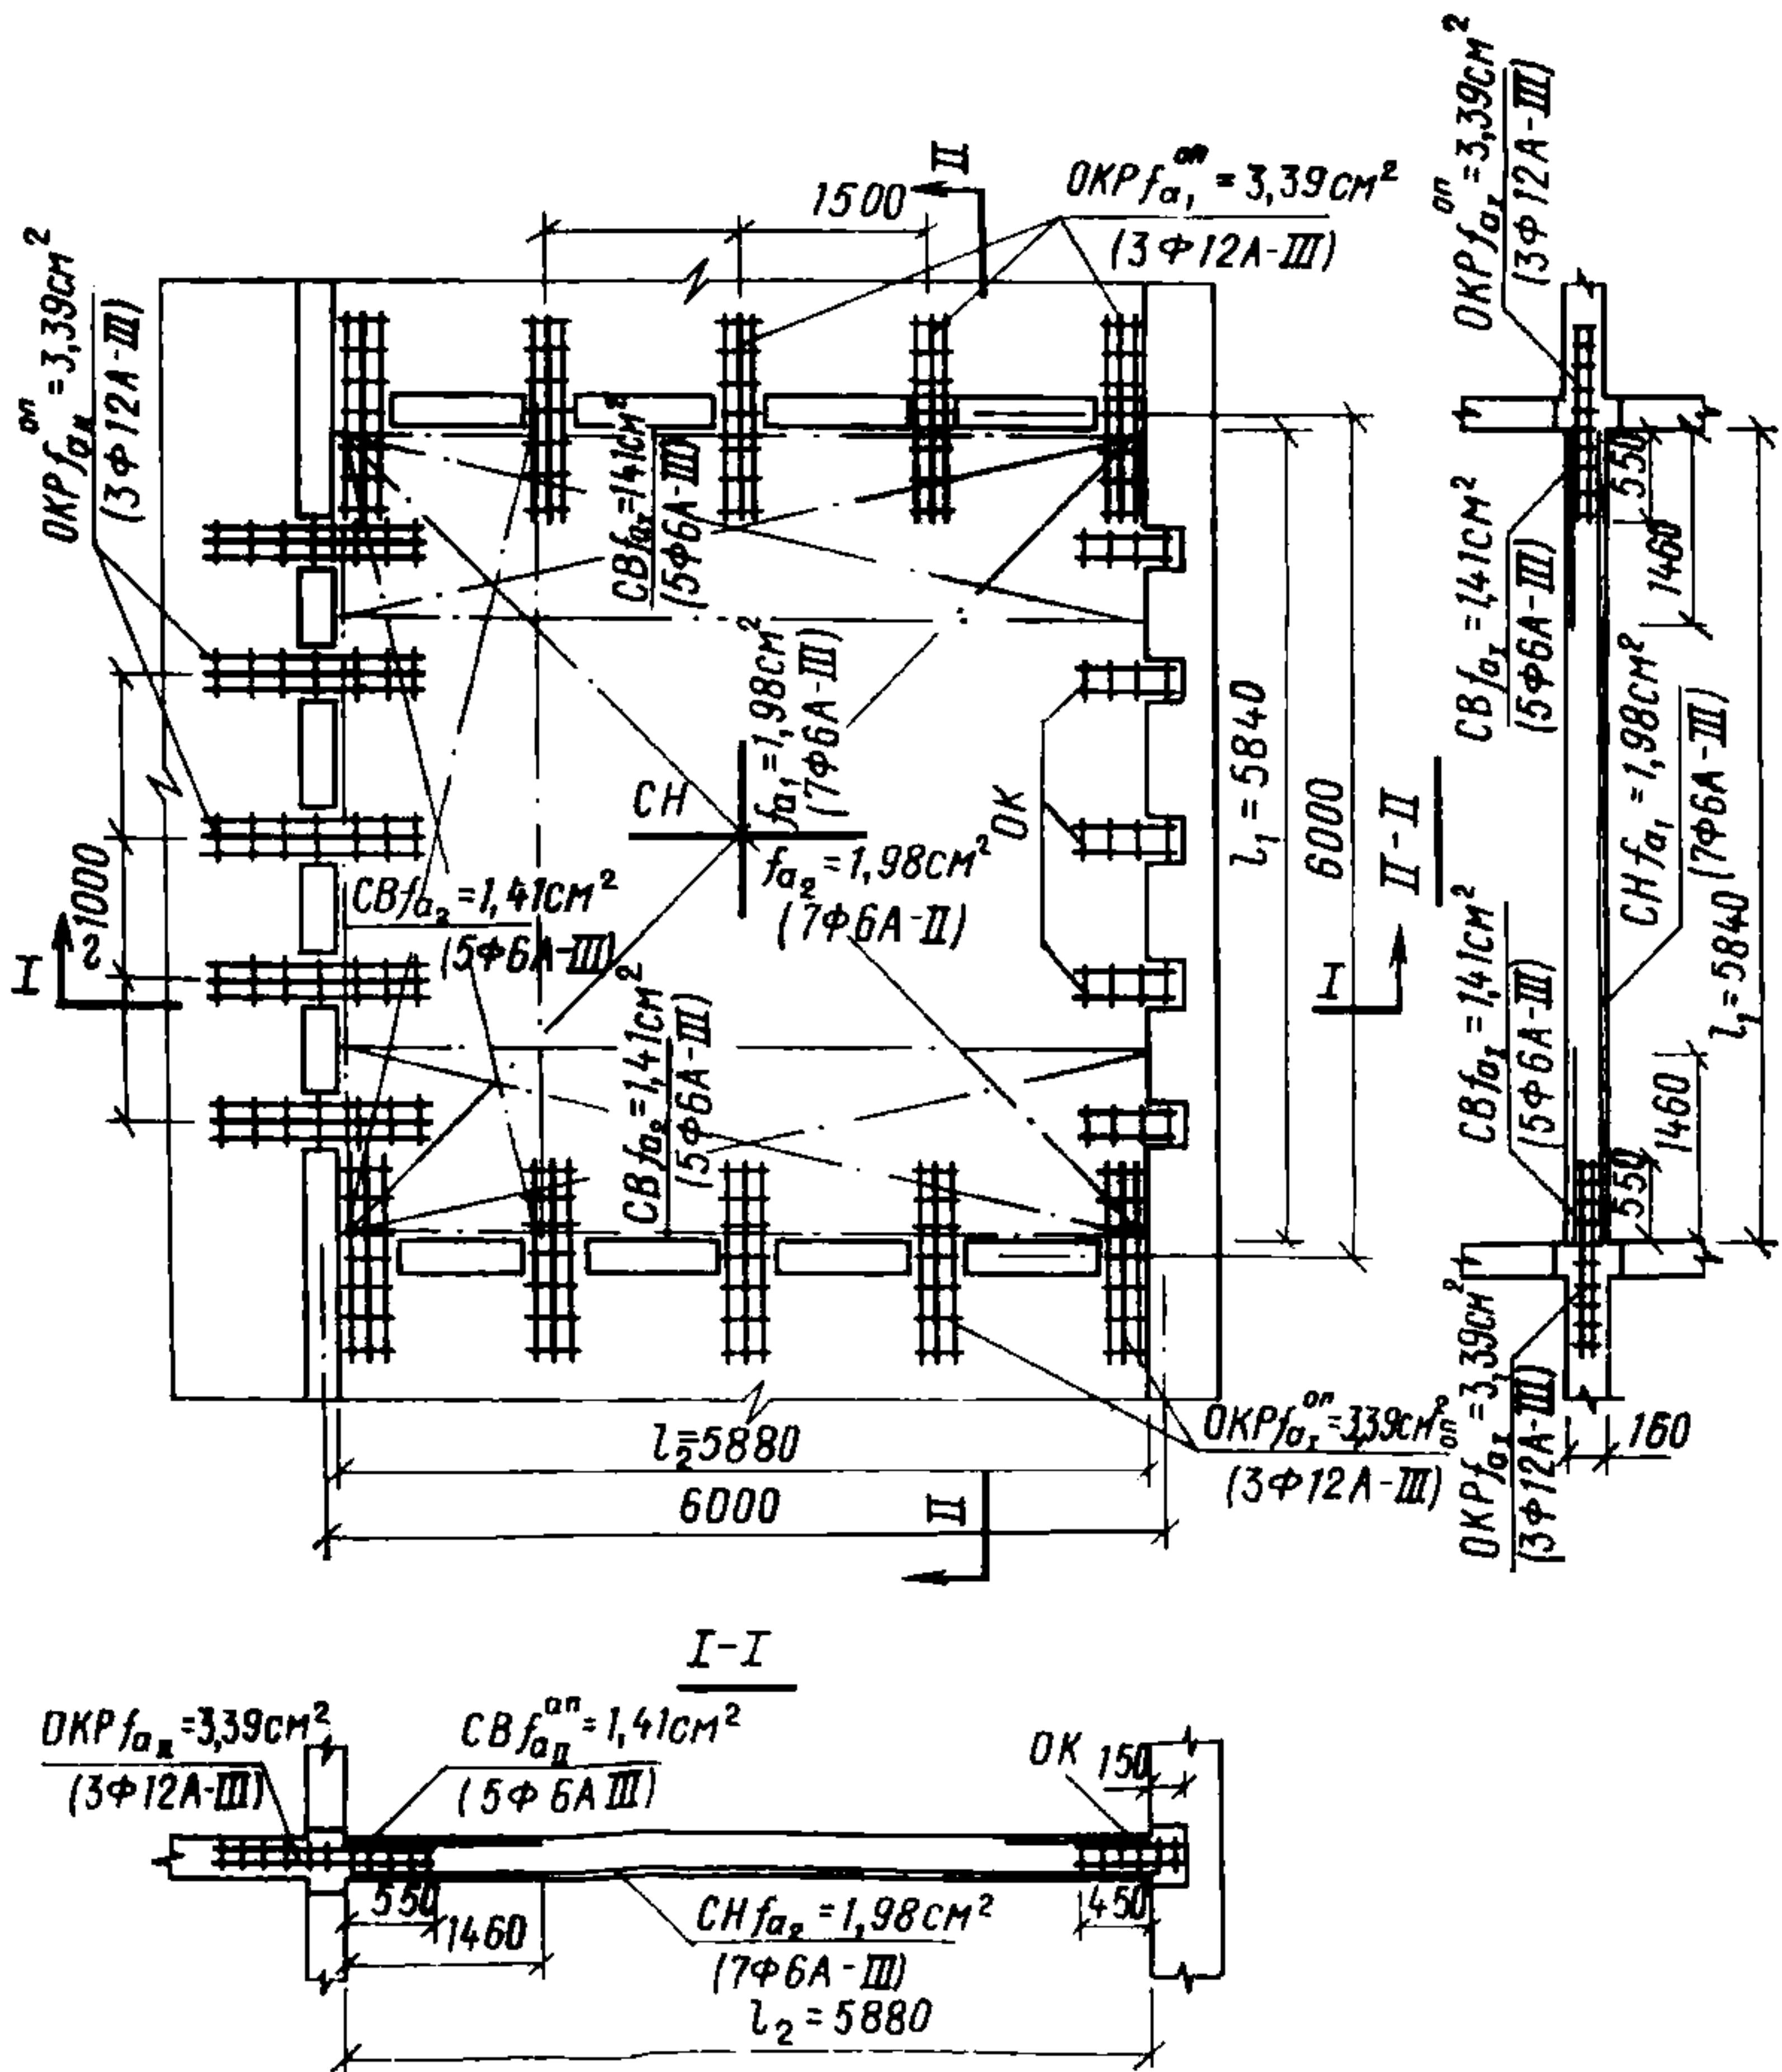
Схема армирования плиты перекрытия с прерывистым опиранием с учетом защемления в опорных зонах
